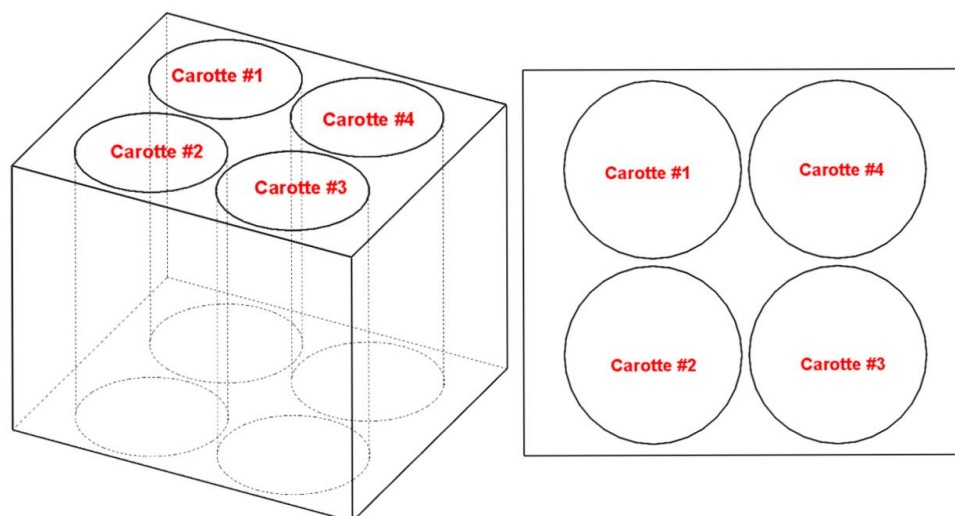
Plan de carottage au laboratoire de l'UQAC
